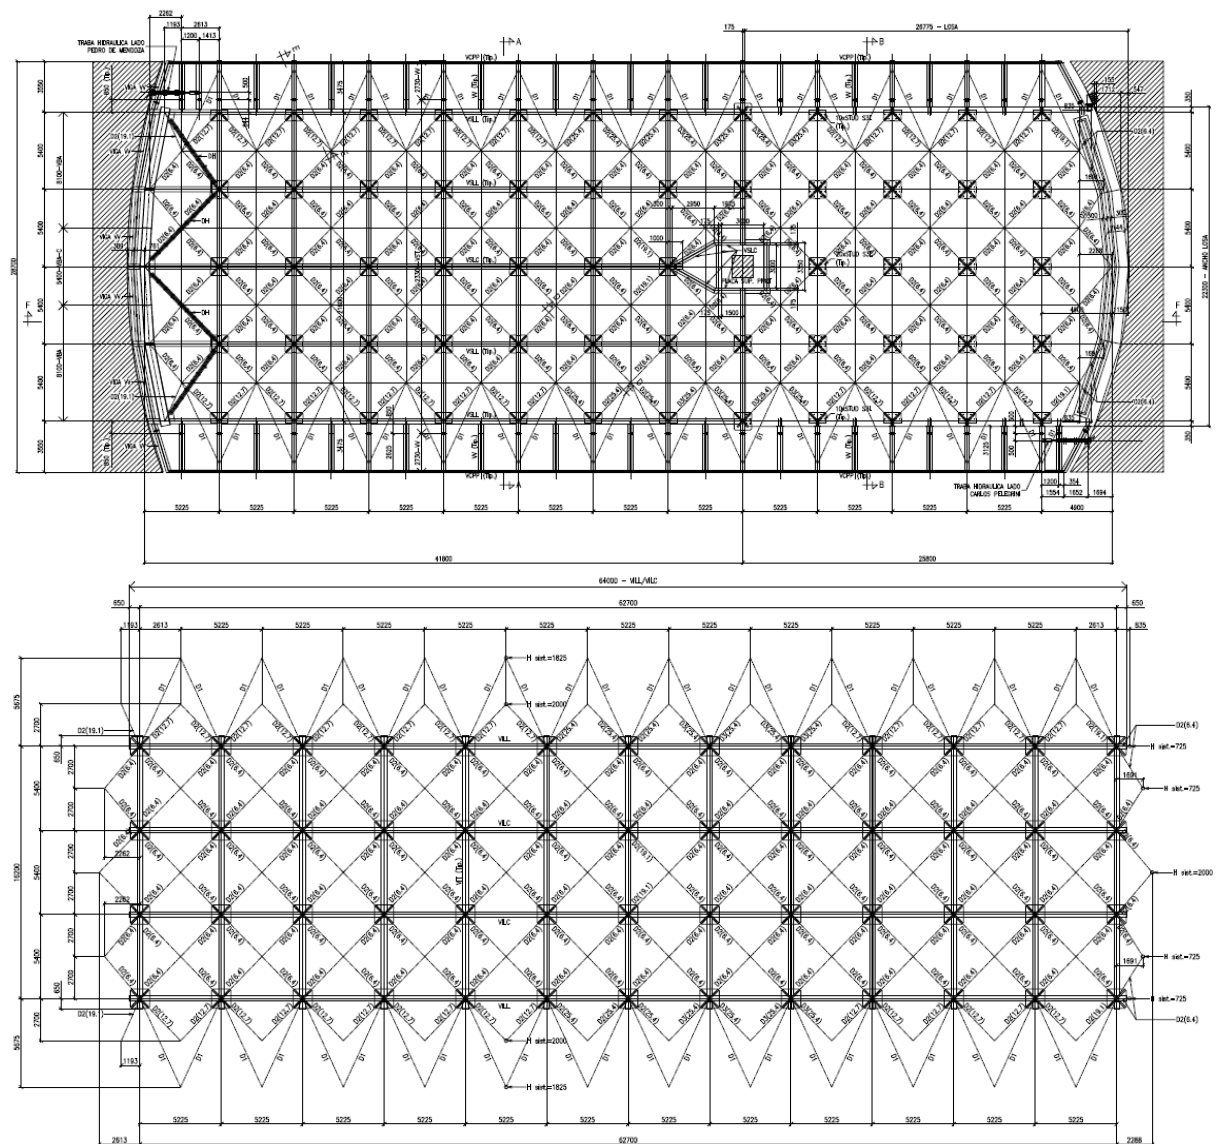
Planta superior e inferior de la estéreo estructura del tablero.
